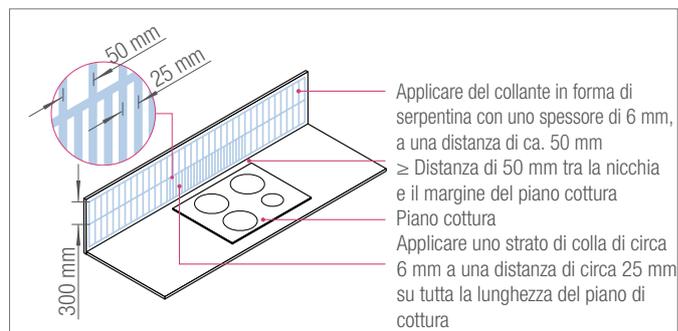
Fissaggio di RAUVISIO crystal alla parete posteriore
